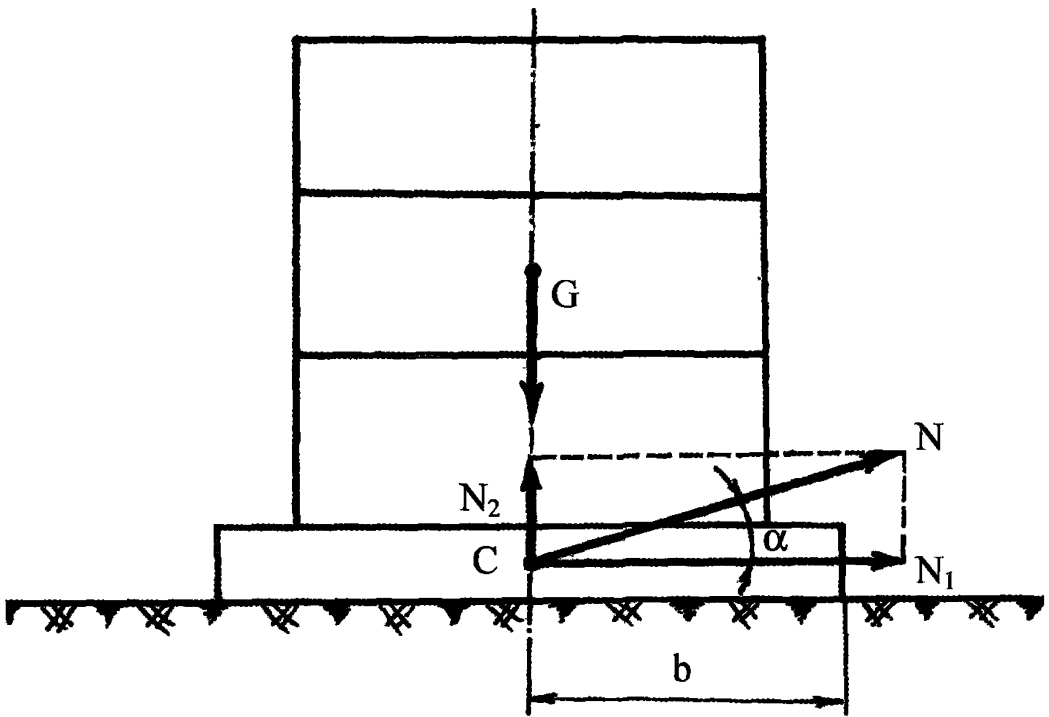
Расчетная схема бетонной наземной анкерной опоры гравитационного типа
